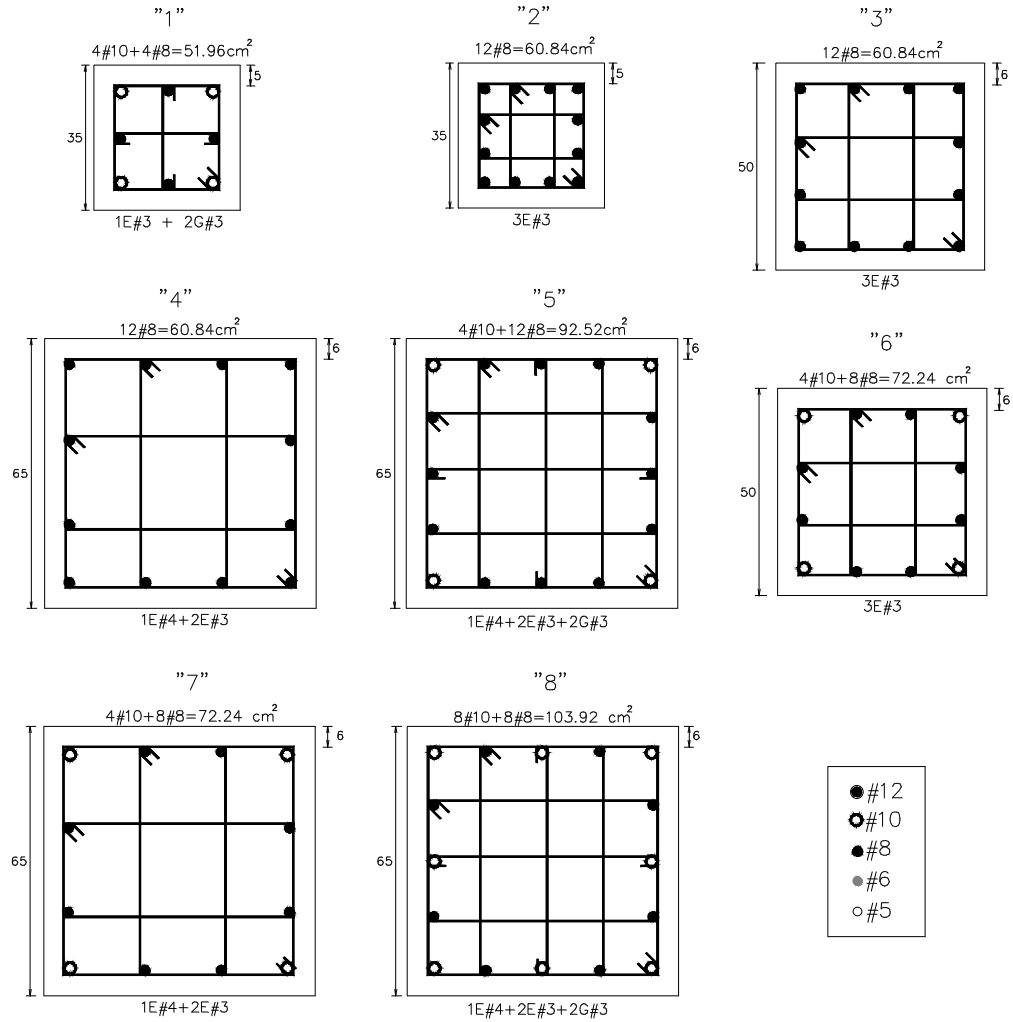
Tipos de armados propuestos para las columnas del eje 2, estructuras de 7 niveles diseñadas en zona II (RDF-93 y RDF-04)
